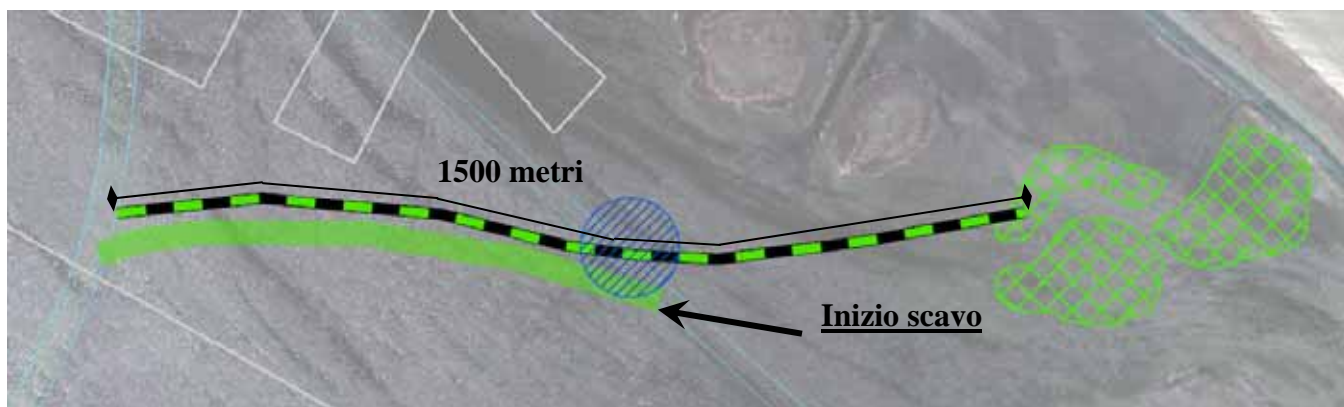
Disposizione tubazione per lo scavo del canale 2
